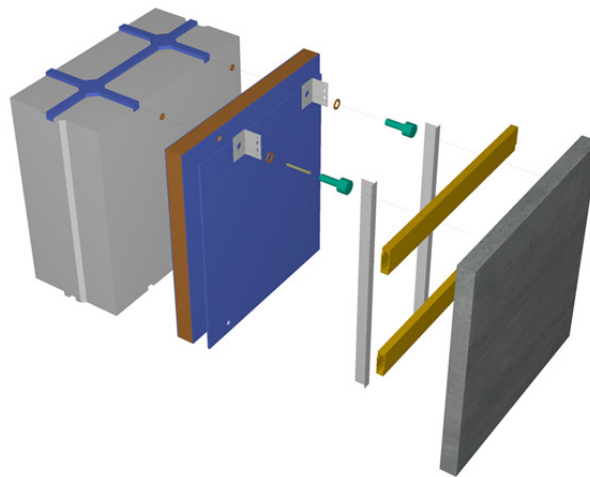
Explosionszeichnung Wandaufbau mit Textilbetonplatten
